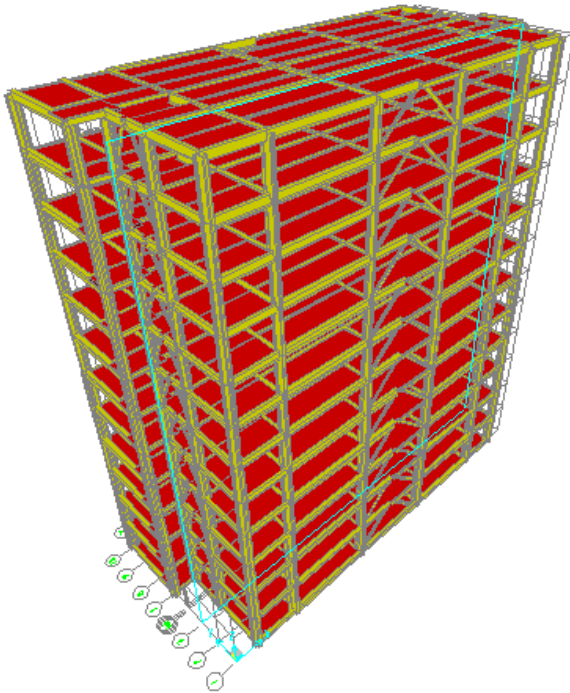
Denah Struktur Hotel Fave Ketintang Surabaya
